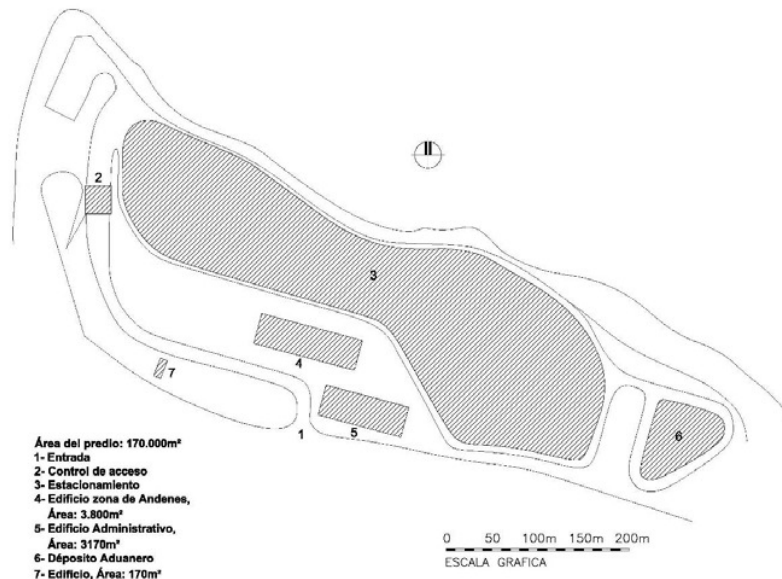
Planta general del predio – Puerto Terrestre Los Andes
